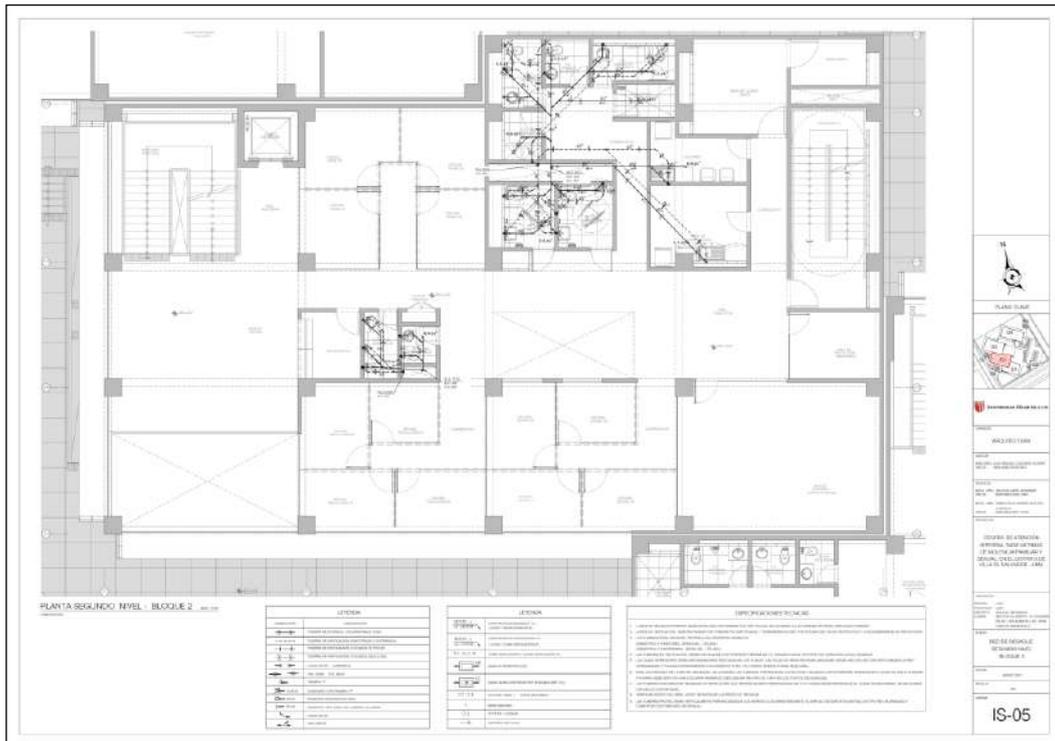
Planta segundo nivel red de desagüe – bloque 2.
